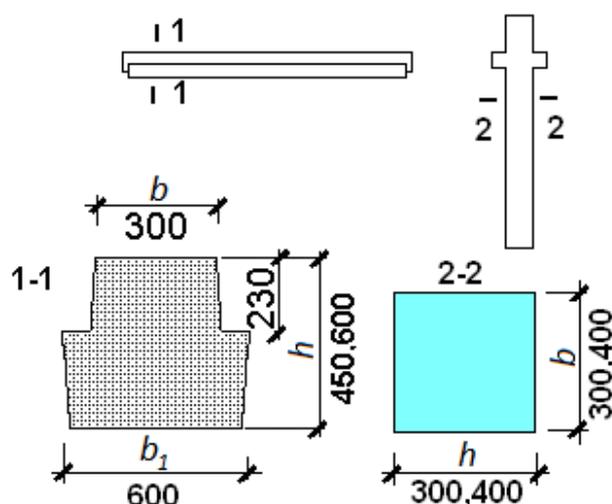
Размеры поперечных сечений колонн и ригелей многоэтажных каркасных зданий
